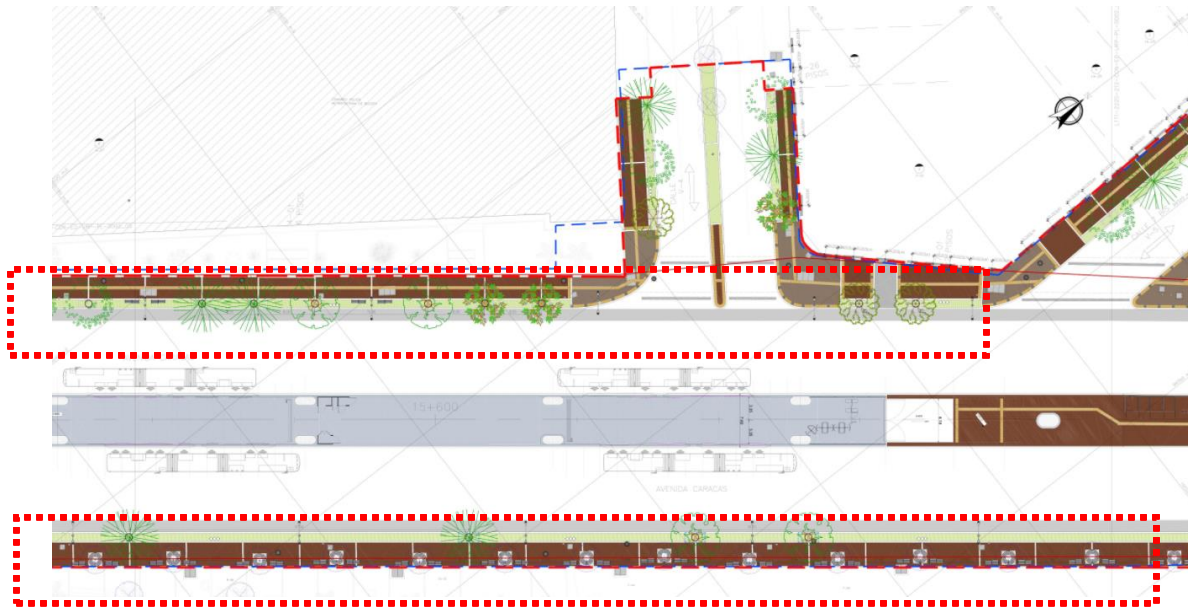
Planta arbolado paisaje lineal estructurante interestación 212
